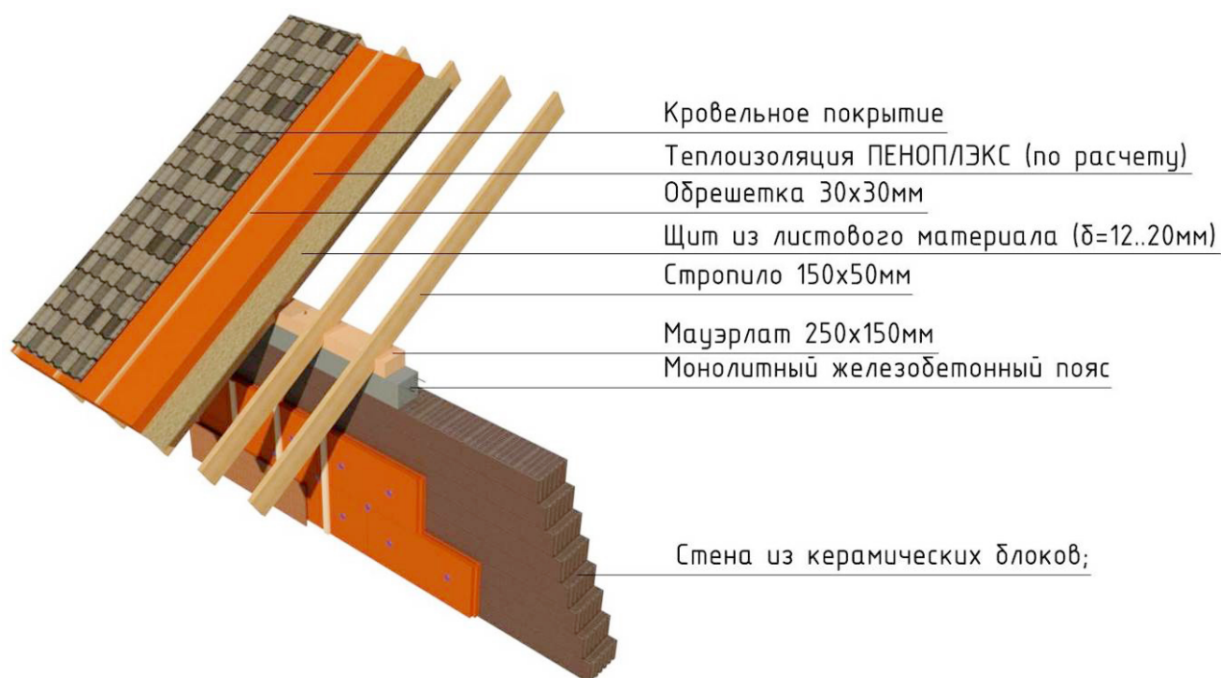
Схема примыкания теплоизолированной стены из керамических блоков к стропильной системе скатной кровли.
